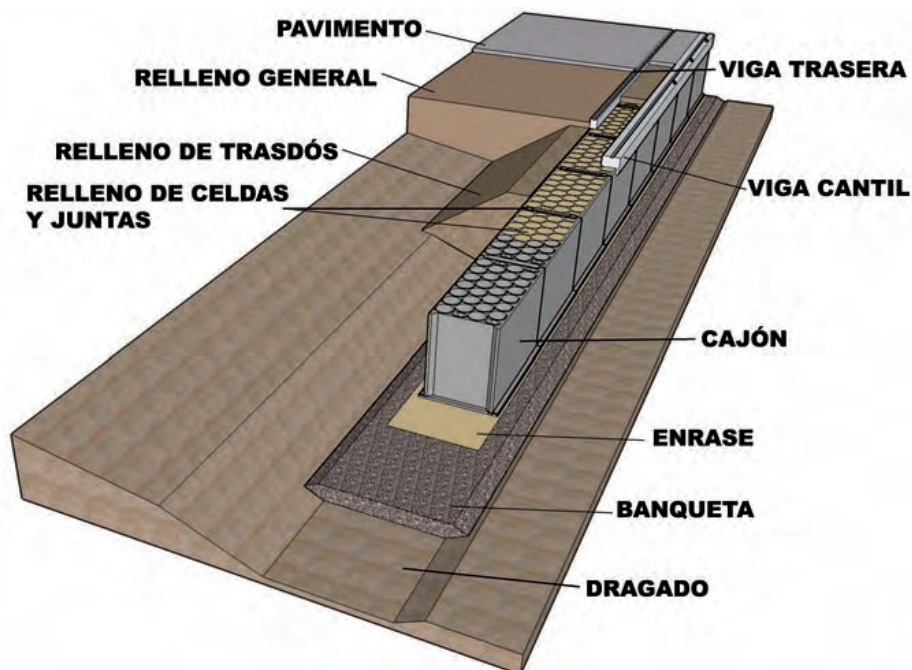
a C Secuencia constructiva muelle de cajones
